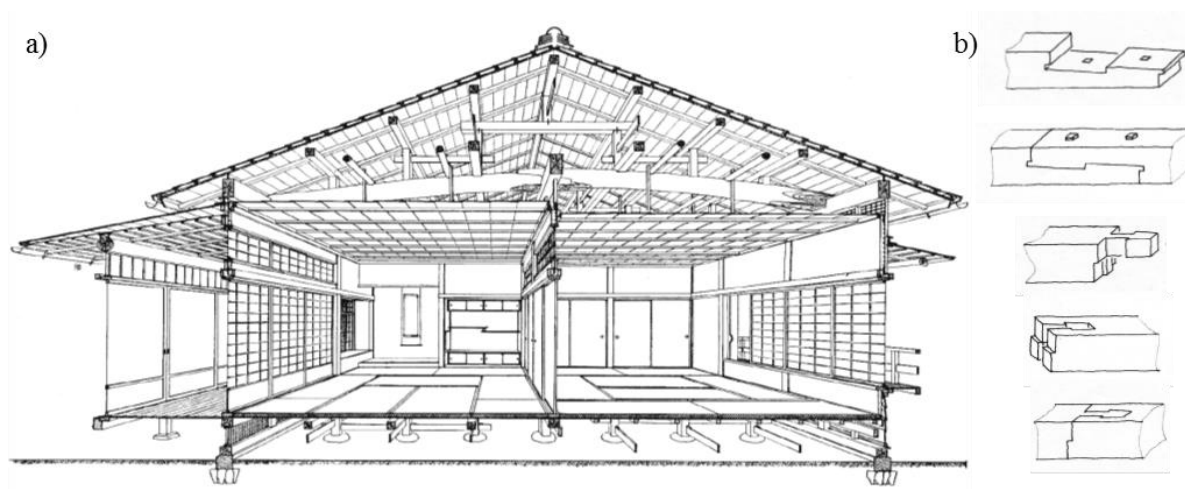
traditionelles japanisches Wohnhaus: a) Querschnitt, b) Holzverbindungen (Kujawski, 1972)
